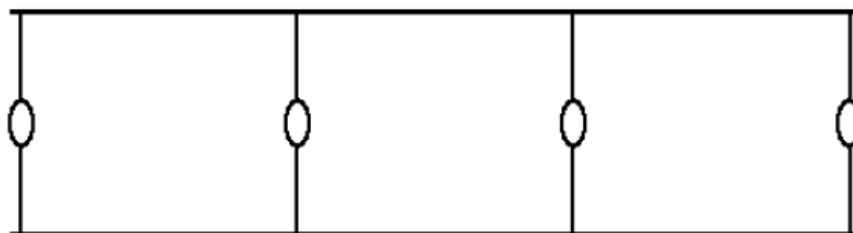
Croqui (planta baixa) da disposição das luminárias públicas (canteiro central)
